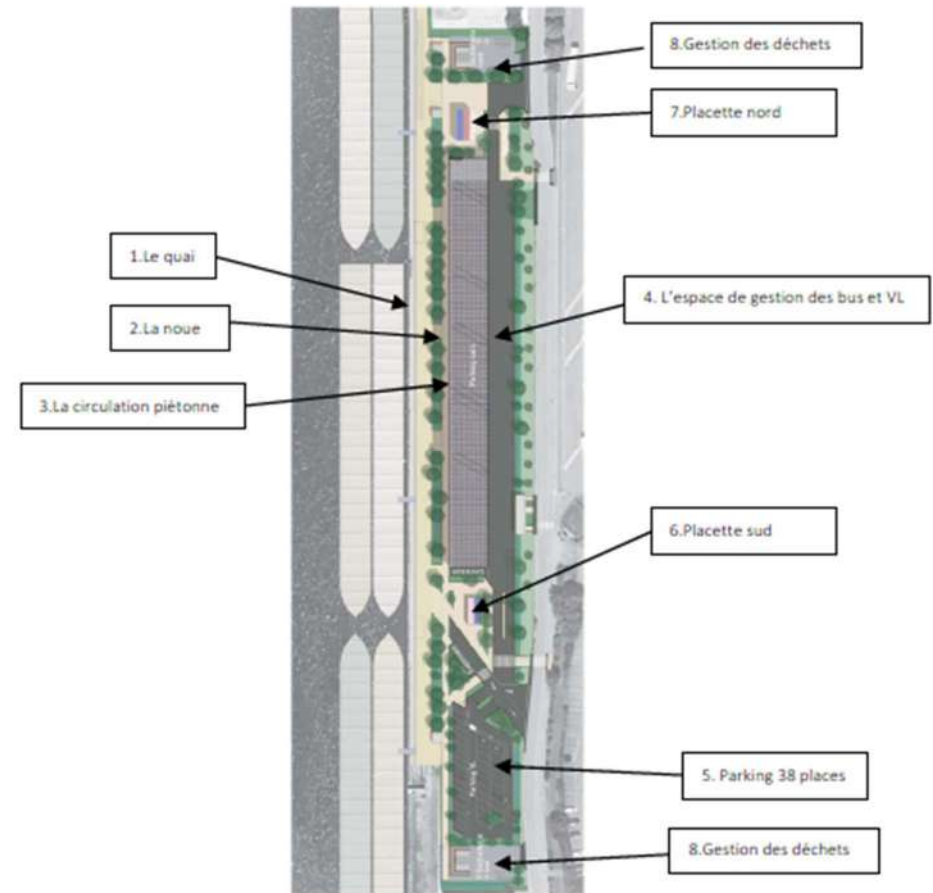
PLAN MASSE AVP DES AMENAGEMENTS
